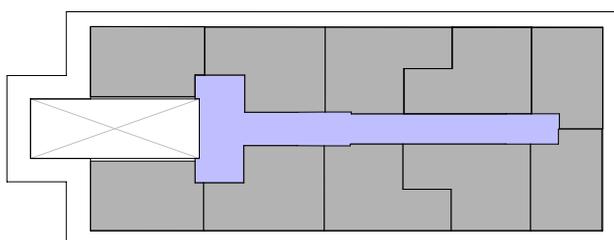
Planteamiento 4 de la distribución planta primera.
